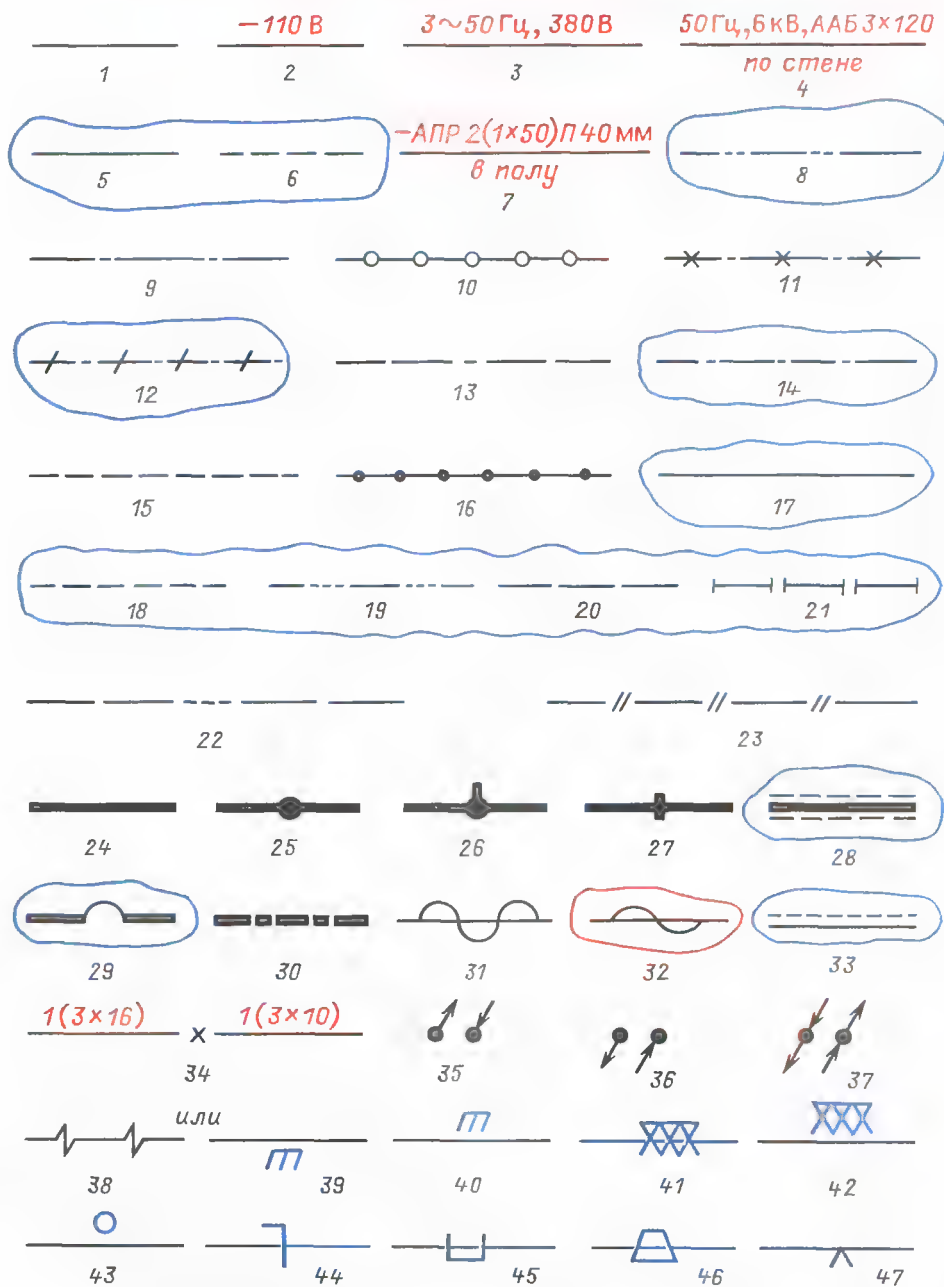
Обозначения линий, проводов и токопроводов на планах
